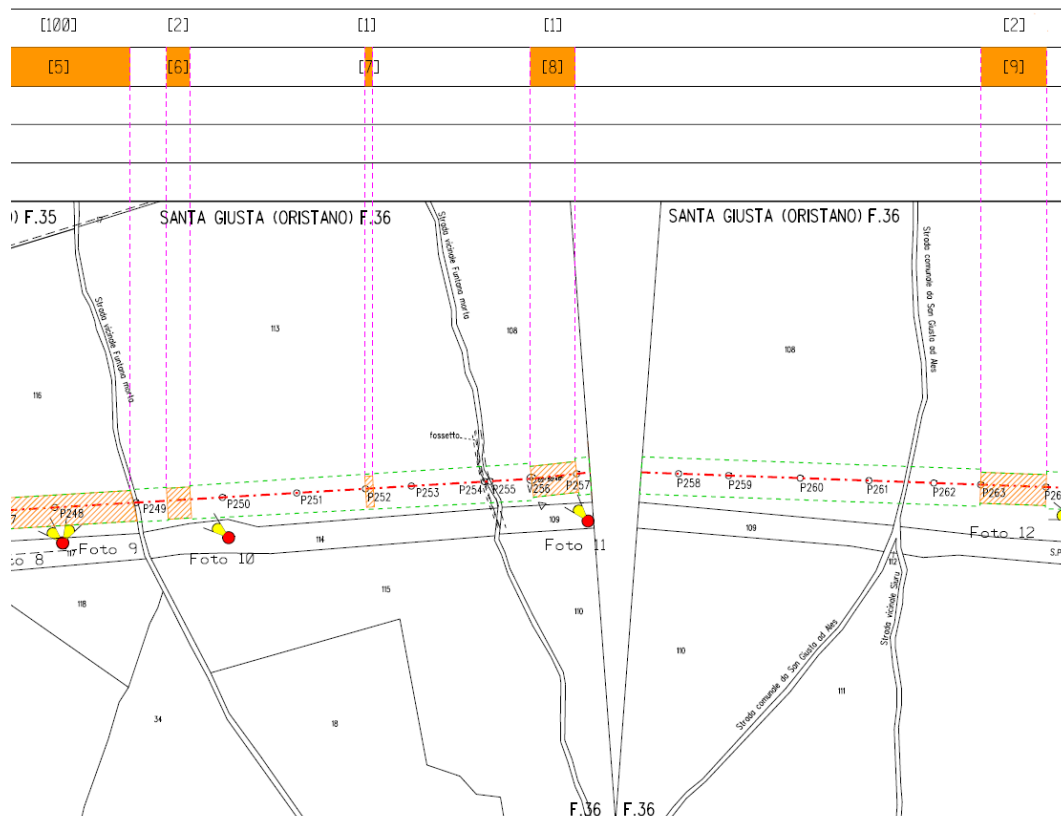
Tratto P256 – P257 - la zona delimitata dalle linee verdi rappresenta la fascia ristretta di lavoro per come previsto dalla GASD C 13.40.10.02
